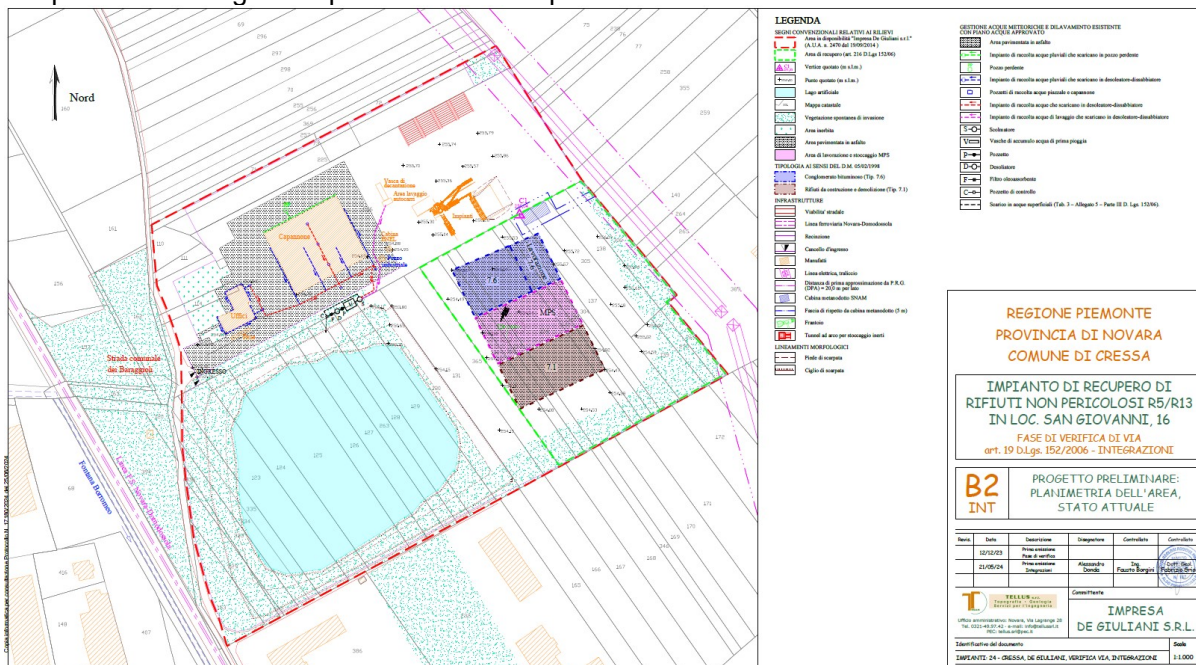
Planimetria impianto-stato attuale (tavola B2int del 21/05/2024)
